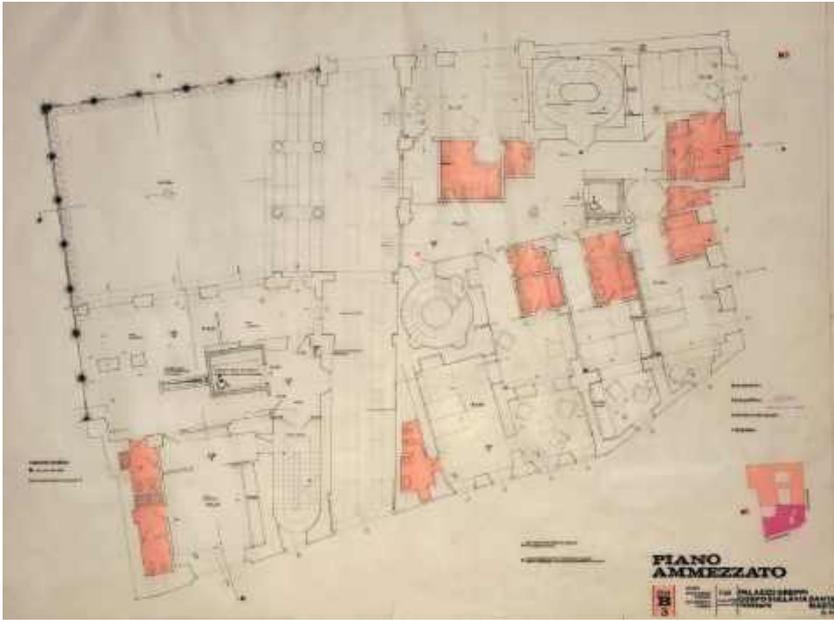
Corpo su via Santa Marta, pianta piano ammezzato, progetto di restauro e ristrutturazione; tavola su lucido
